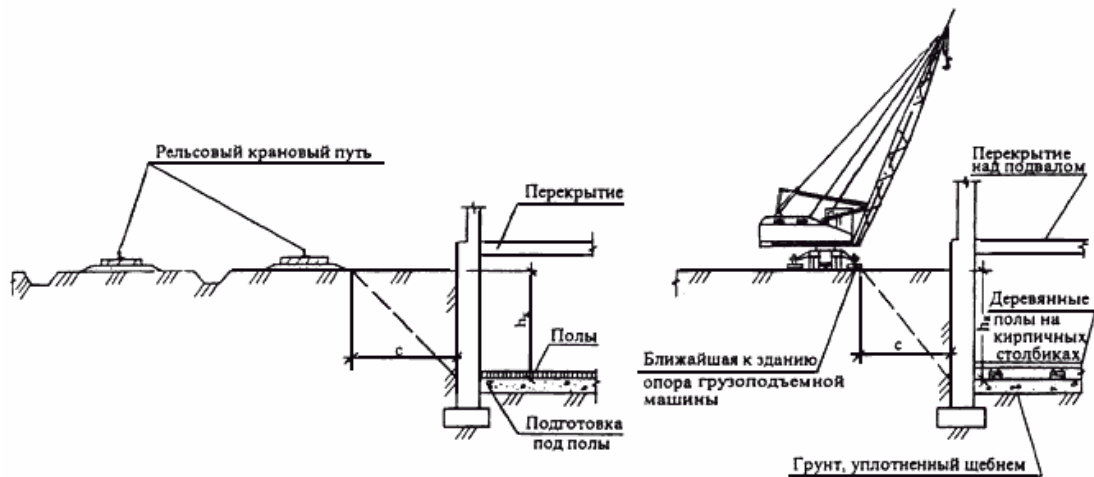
Установка грузоподъемных машин у зданий с подвалом, без расчета выдавливания стен от крановых нагрузок
